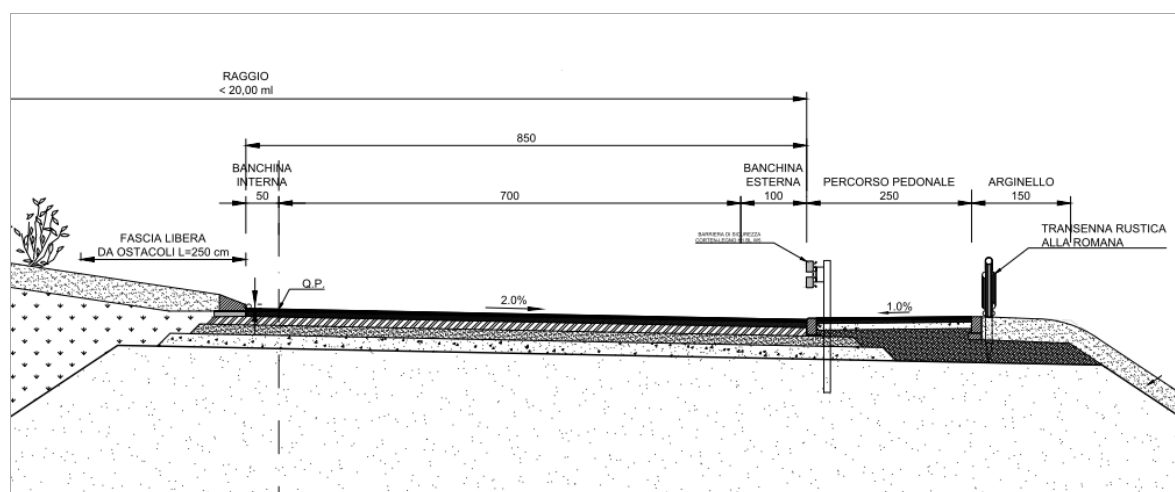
sezione tipo di rotonda affiancata da percorso pedonale separato e protetto
